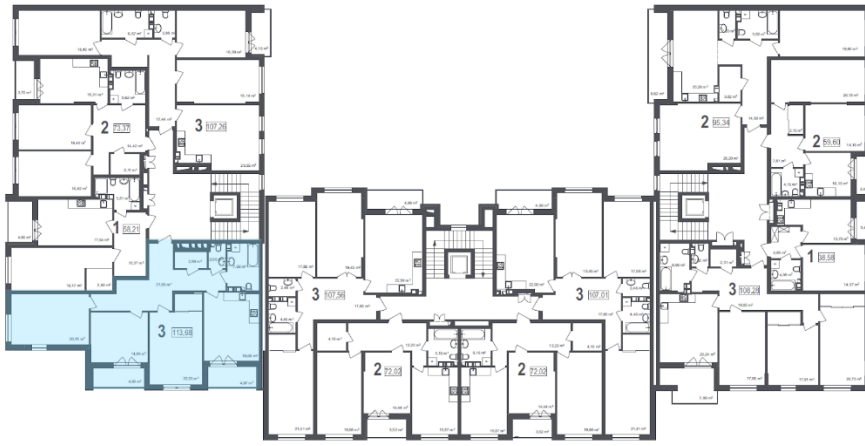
План типового поверху, ЖК Солом'янський, Київ
